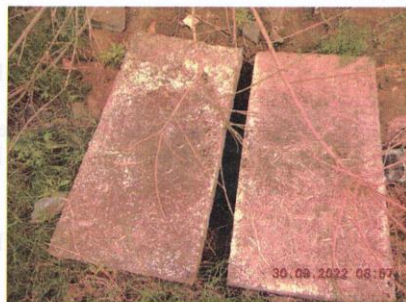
Vista Servidão Pluvial (matr, 81.983).
